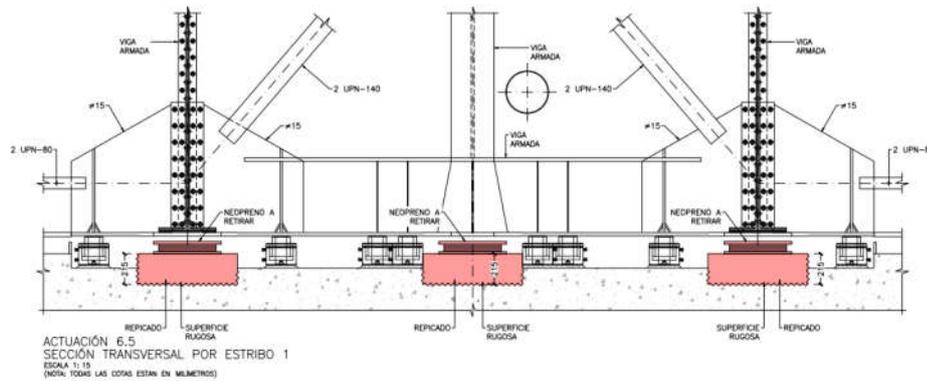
Retirada de apoyos y repicado de zona bajo apoyos
